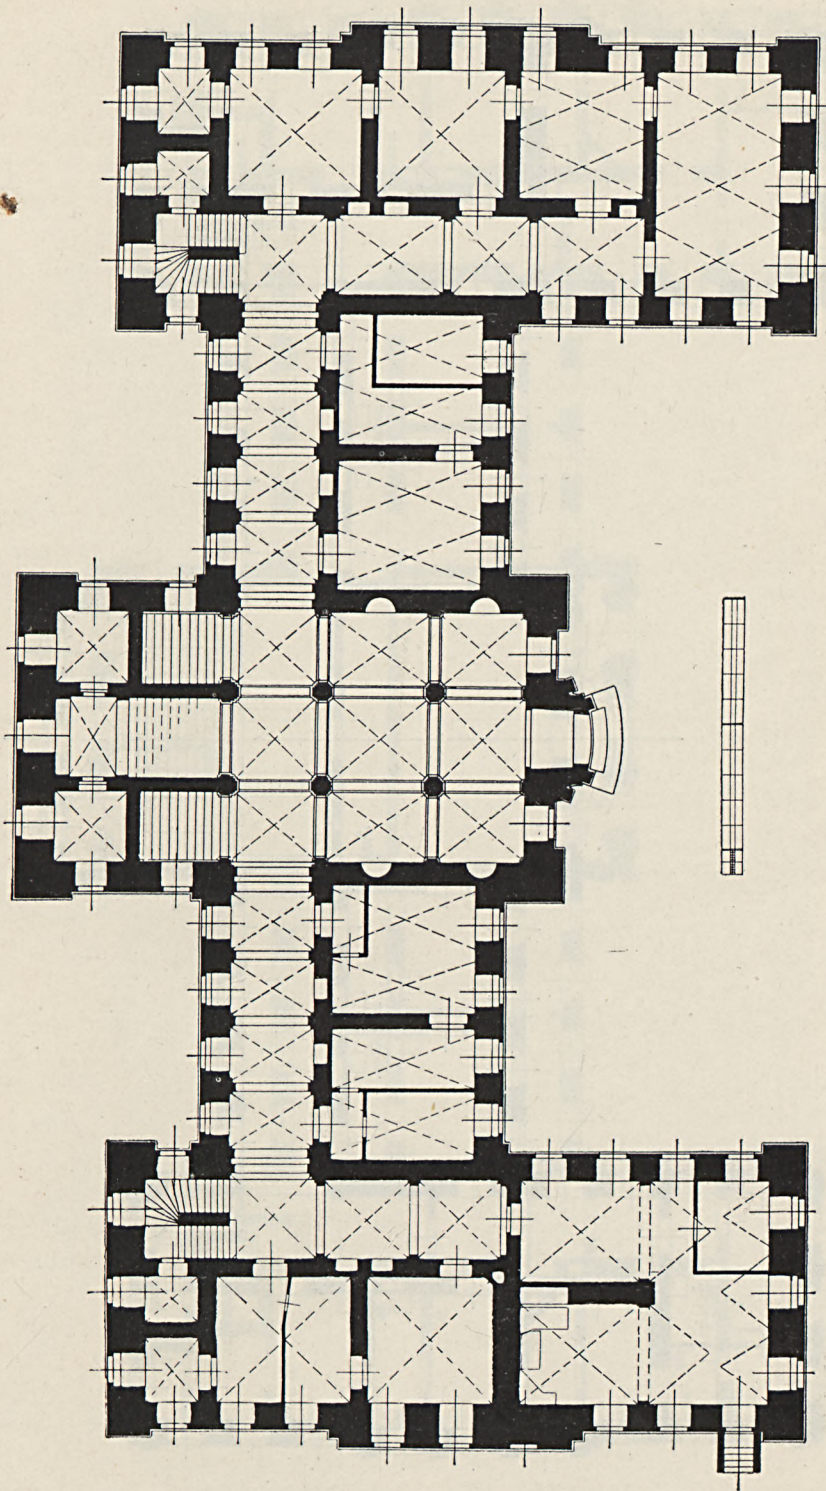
Joachimstein, Schloß, Grundriß des Erdgeschosses.
